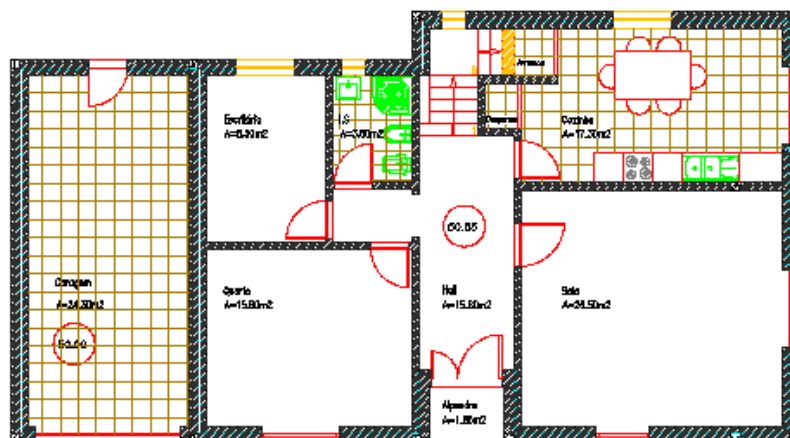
9 - Planta do piso 0 do 3º caso de estudo [19]
